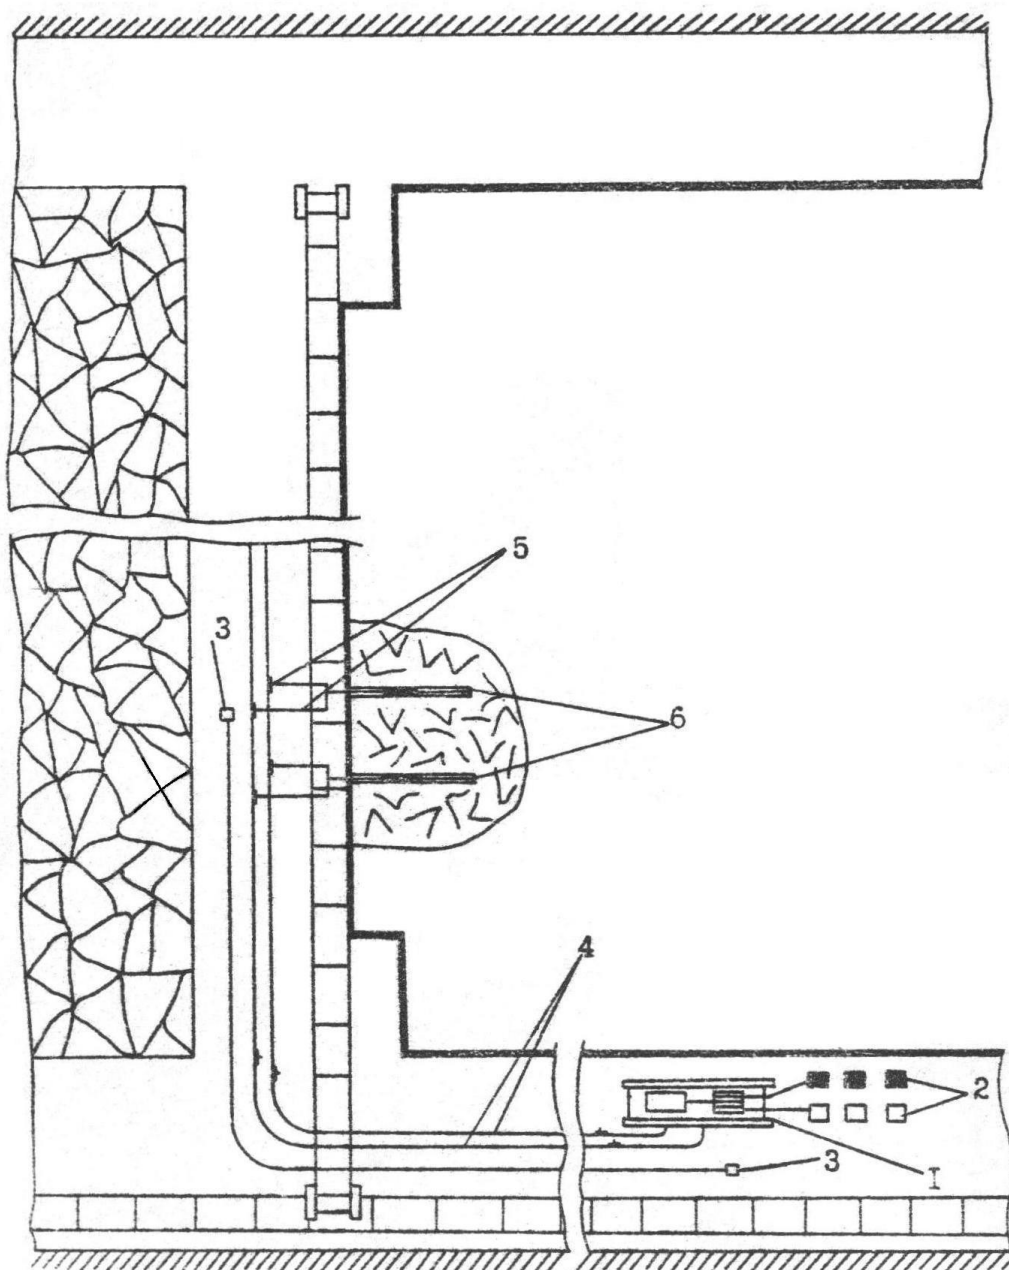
Схема расстановки оборудования при упрочнении пород кровли скрепляющими составами:
